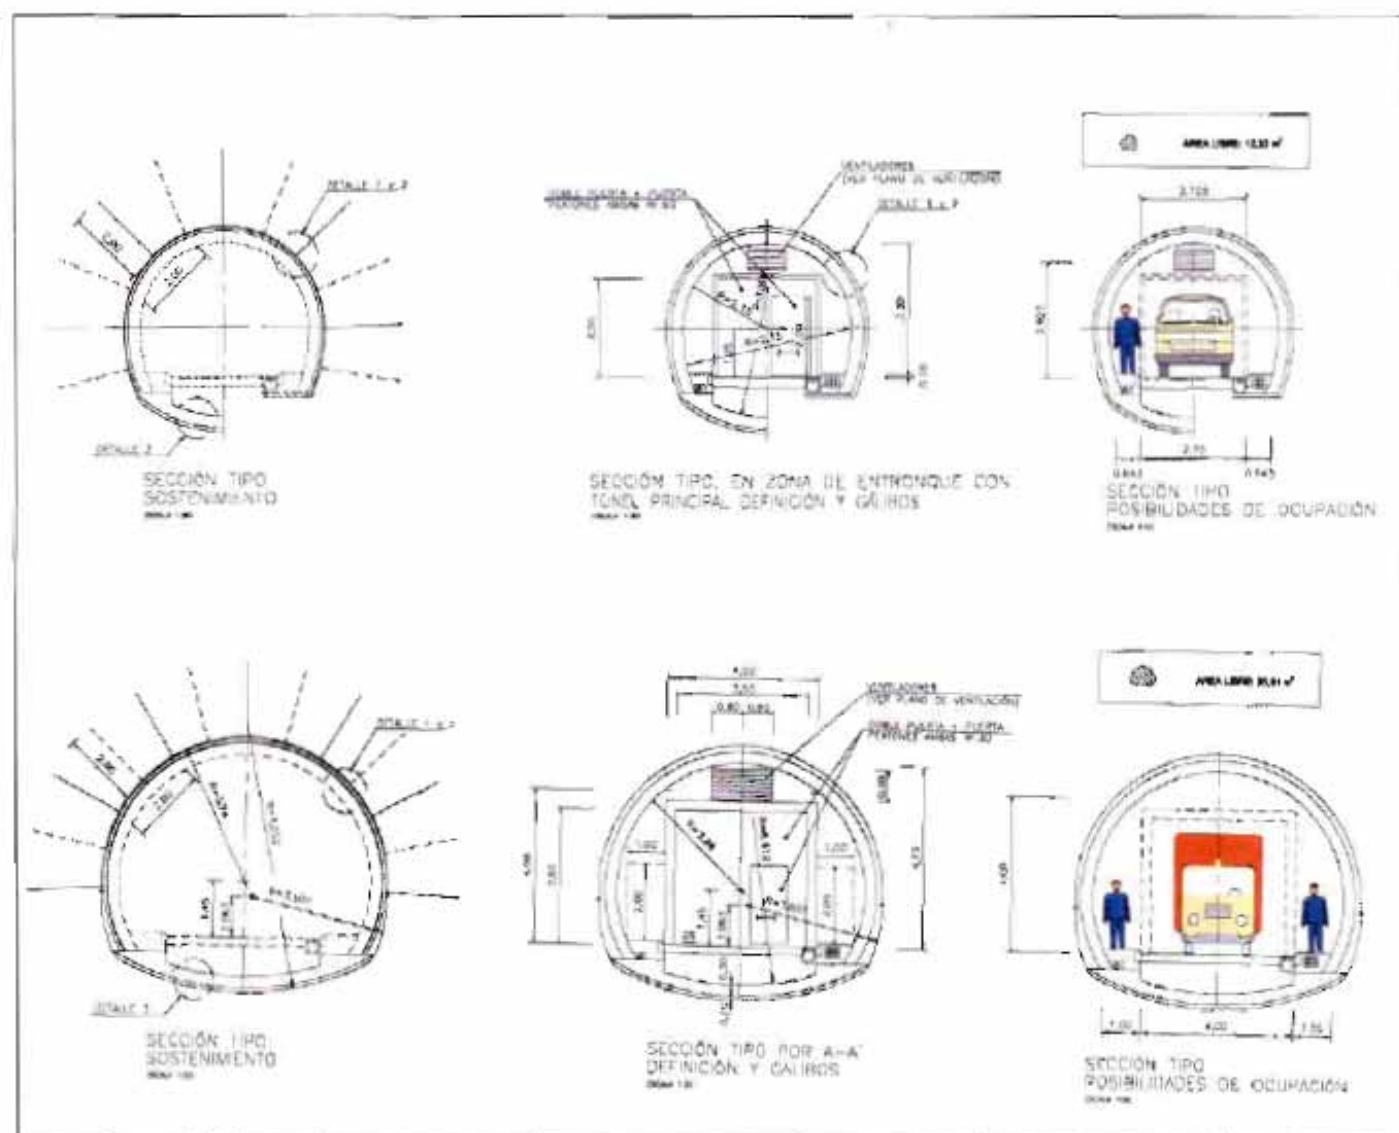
Galerías de escape en los túneles de El Perdón (Ingeotec, 2000).
